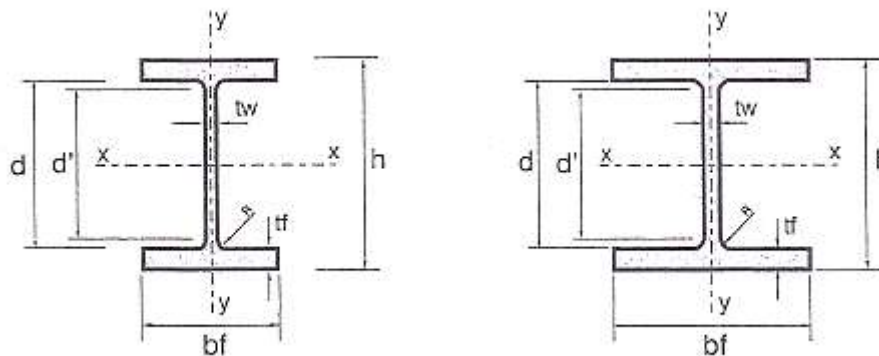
PERFILES LAMINADOS DE ALAS PARALELAS
